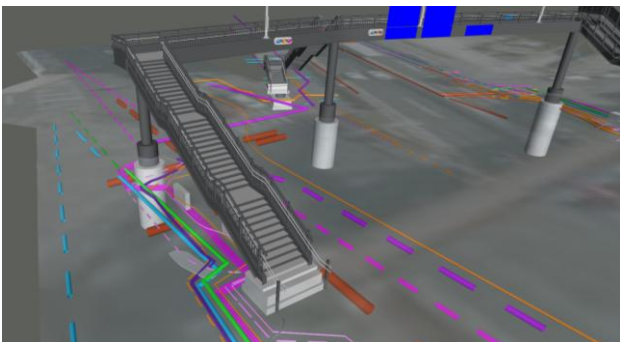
岡崎公園前歩道橋付近の埋設管路移設先検討図
